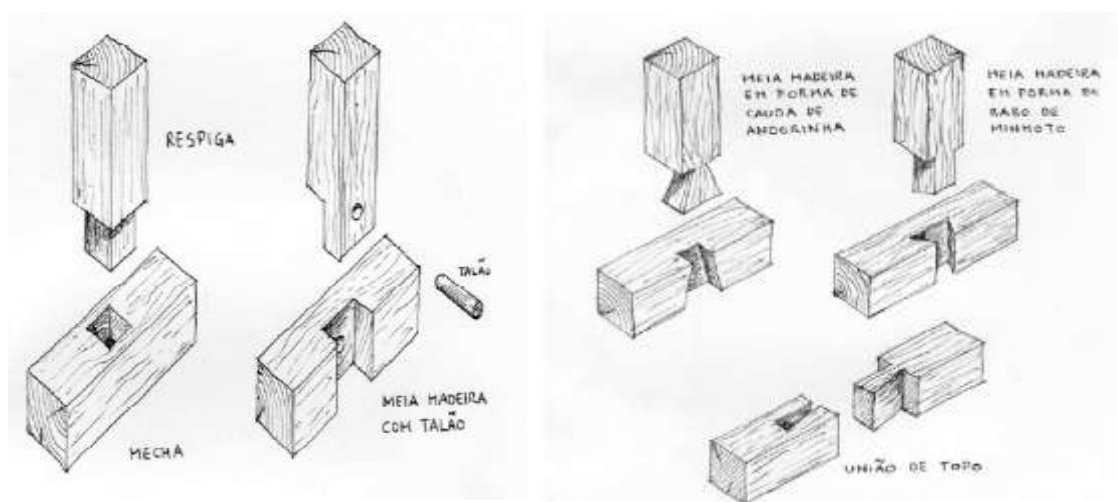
Desenho pormenor tipos de união entre prumos, frechais, travessalhos e vergas de estruturas de madeira de paredes de tabique simples ou de tabique simples reforçado (Retirado de [1]).
